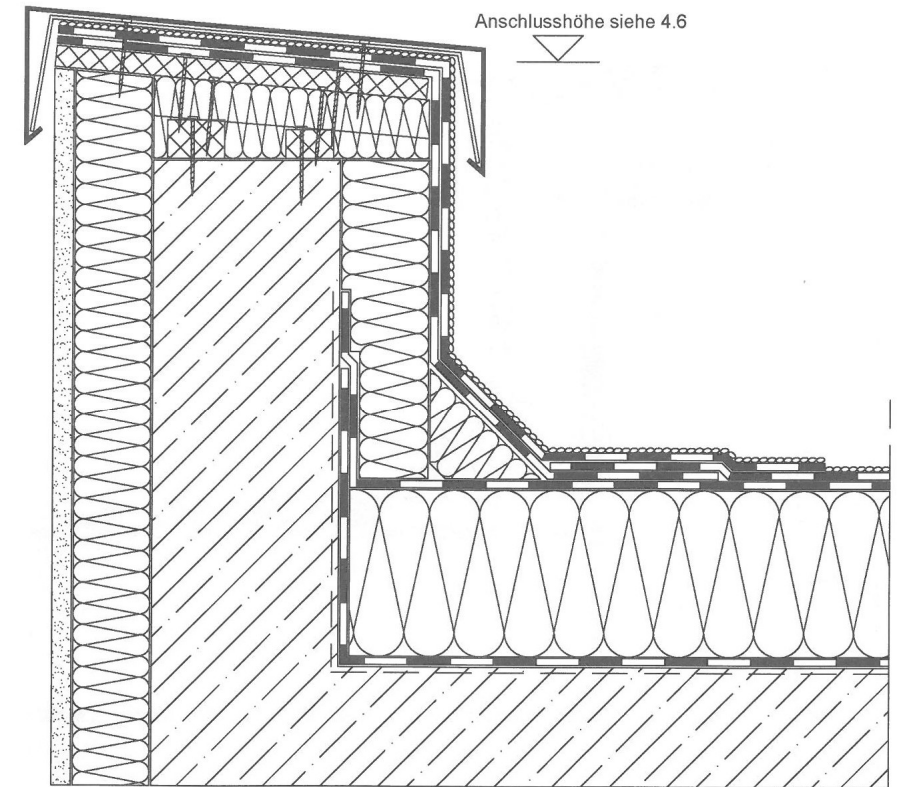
Starrer Dachrandabschluss – Ausführung mit Bitumenbahnen
